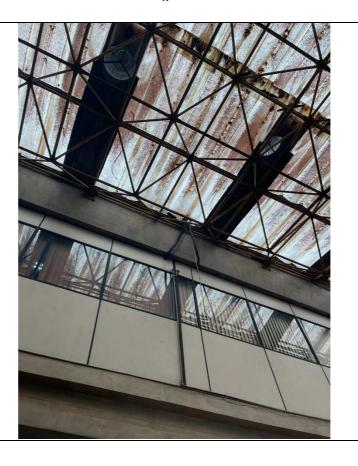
Idem foto 04 - em destaque as instalações que serão removidas e reinstalados de forma adequada.
